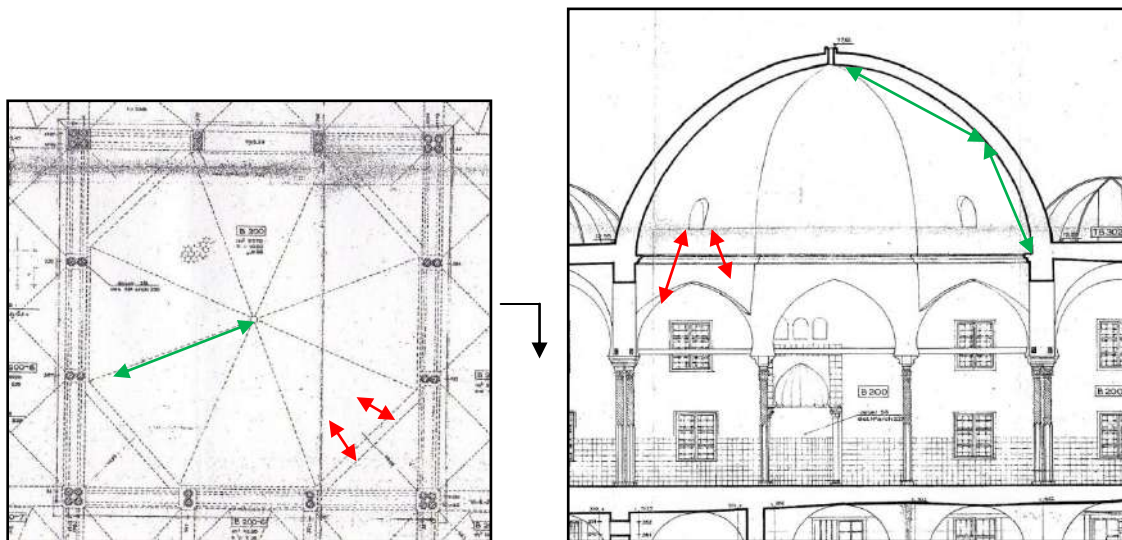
Plan et coupe de la coupole centrale, mosquée du Dey.
